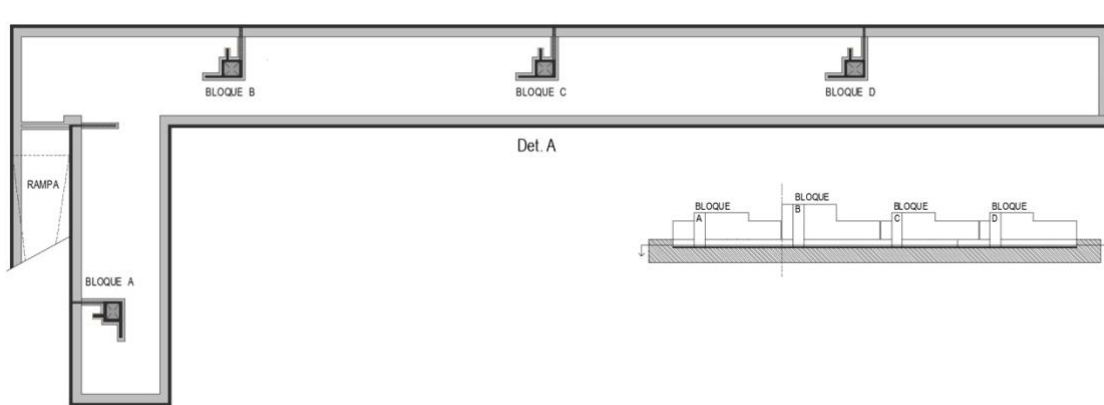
Planta de cimentación. Planta sótano (-3.00m).
